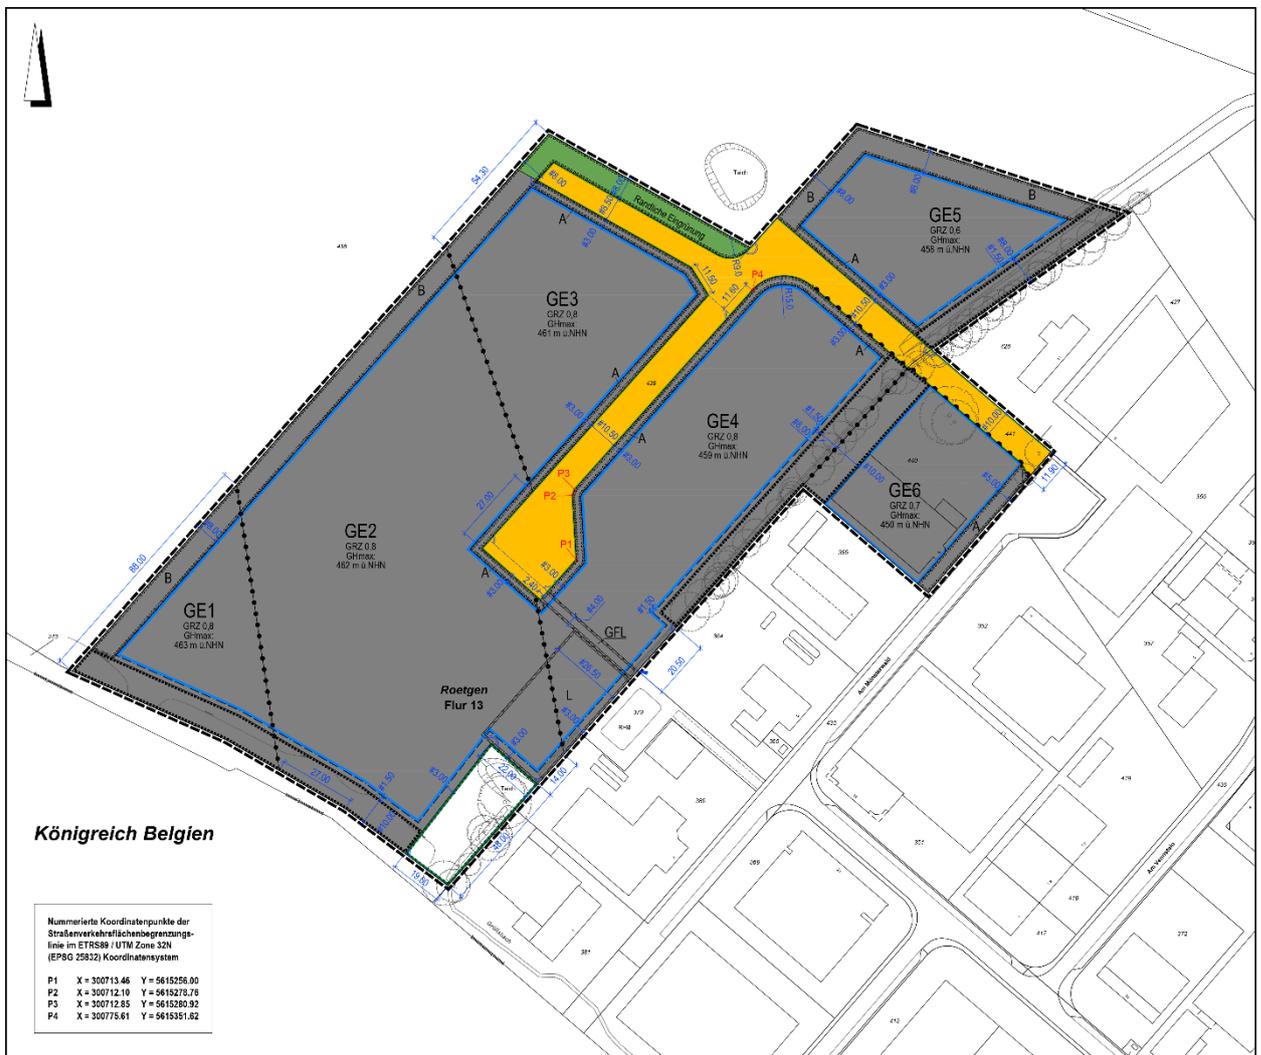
Planzeichnung des Bebauungsplans Nr. 36 ‚Gewerbegebiet Am Vennstein‘
